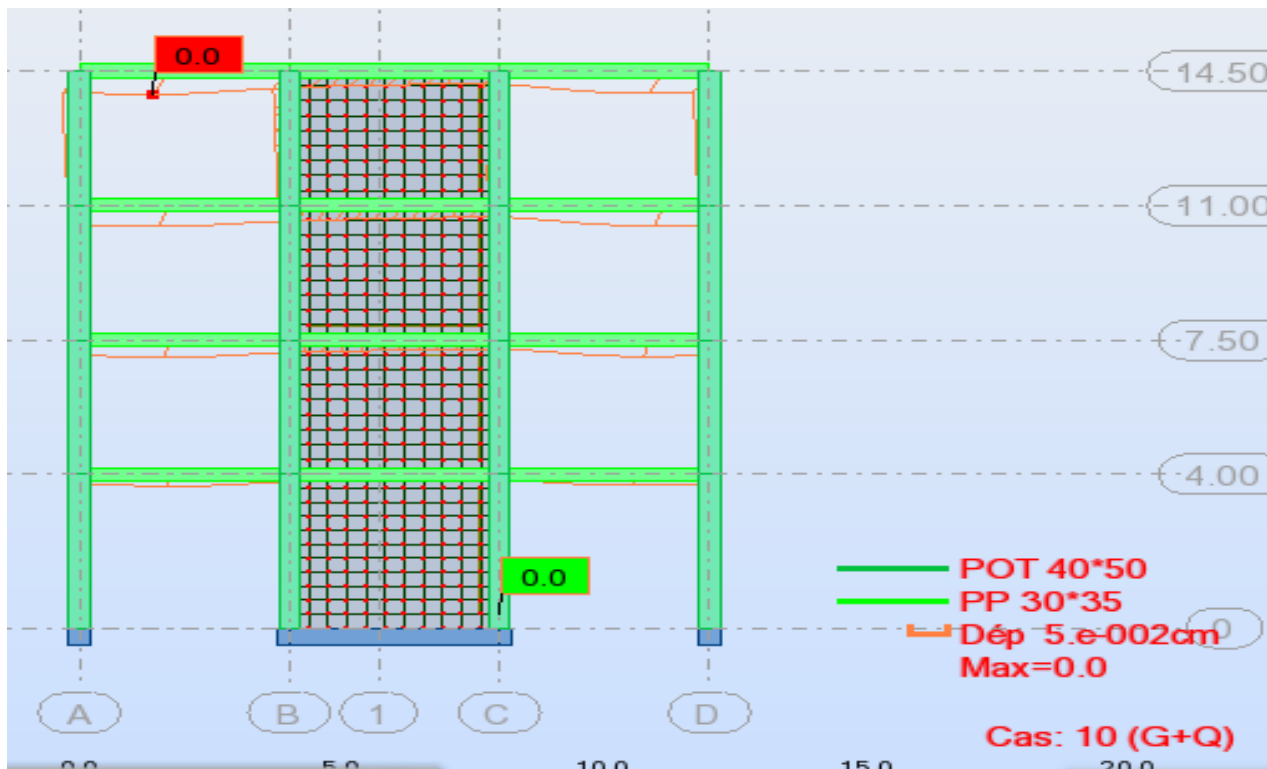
Diagramme de déformation sur les poutres secondaires
